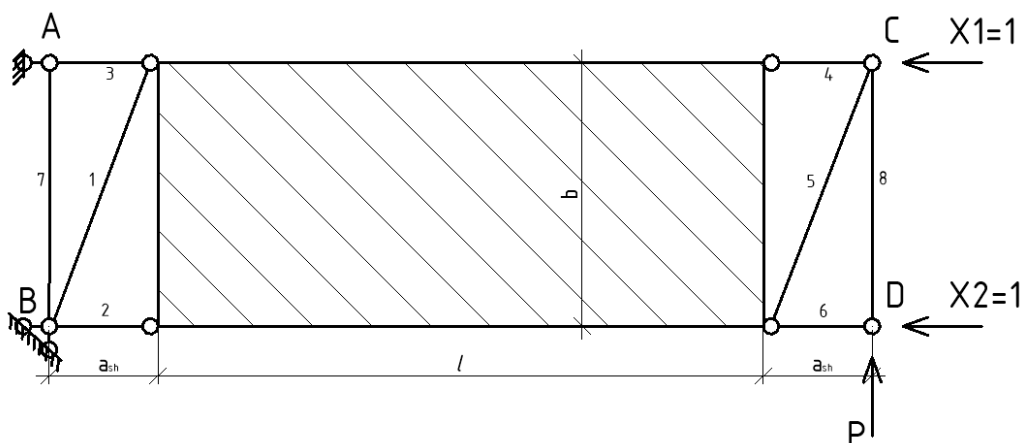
Расчетная схема для определения перемещений плиты или ячейки перекрытия от горизонтальной нагрузки где:
